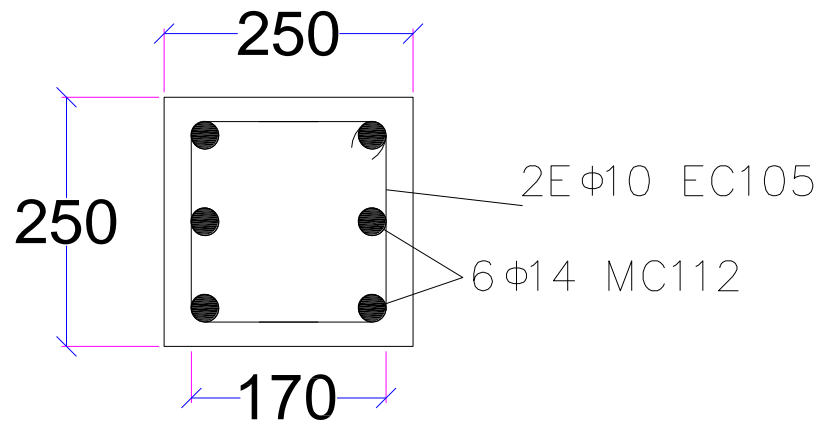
Descripción de la cadena de amarre. Sección típica, acero de refuerzo, relleno compactado con material de sub-base triturada.
